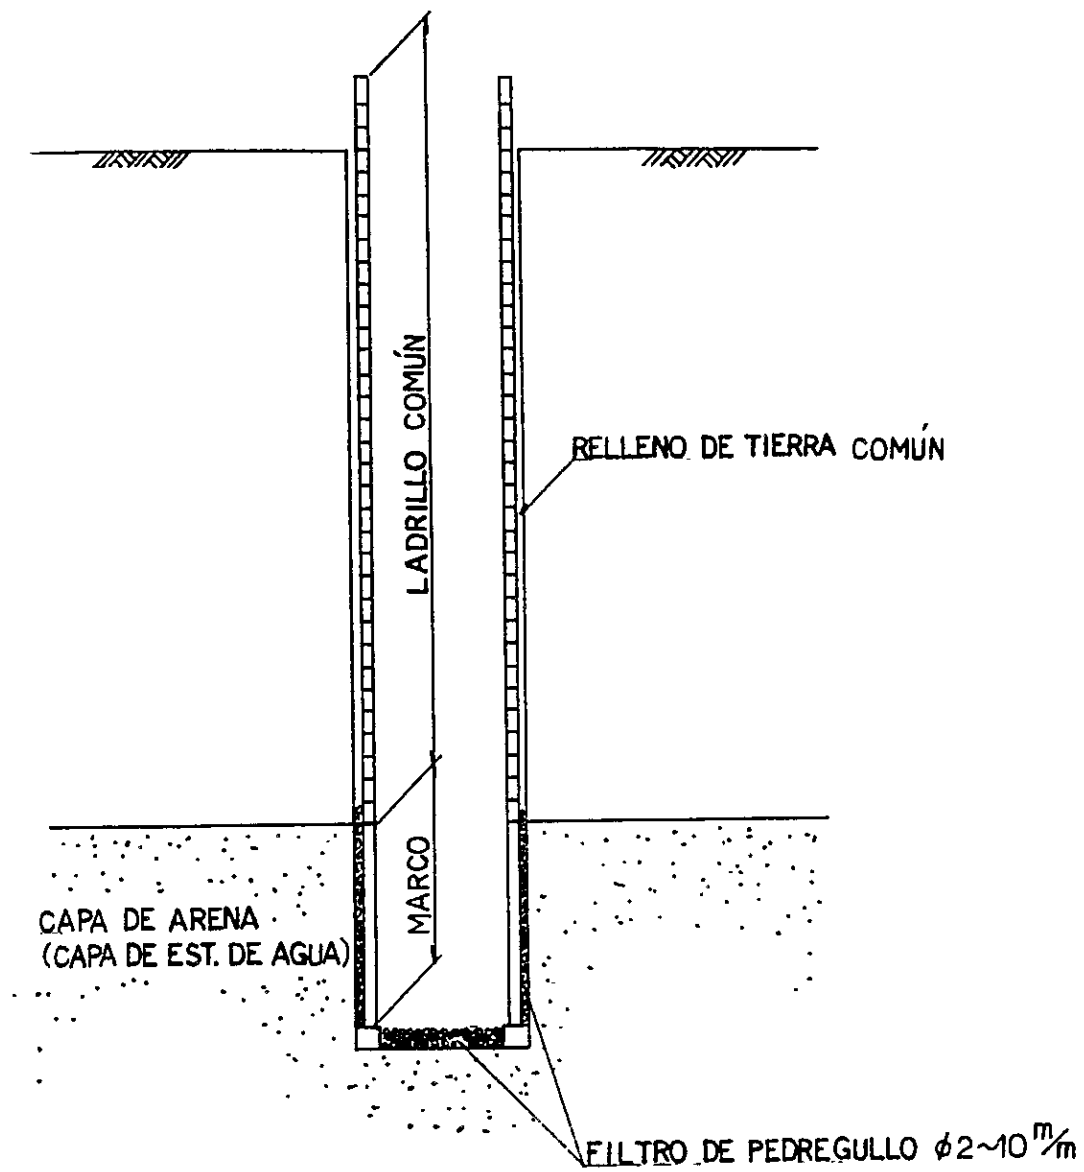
PLANO DE ESTRUCTURA NORMAL DE POZO COLONOS
